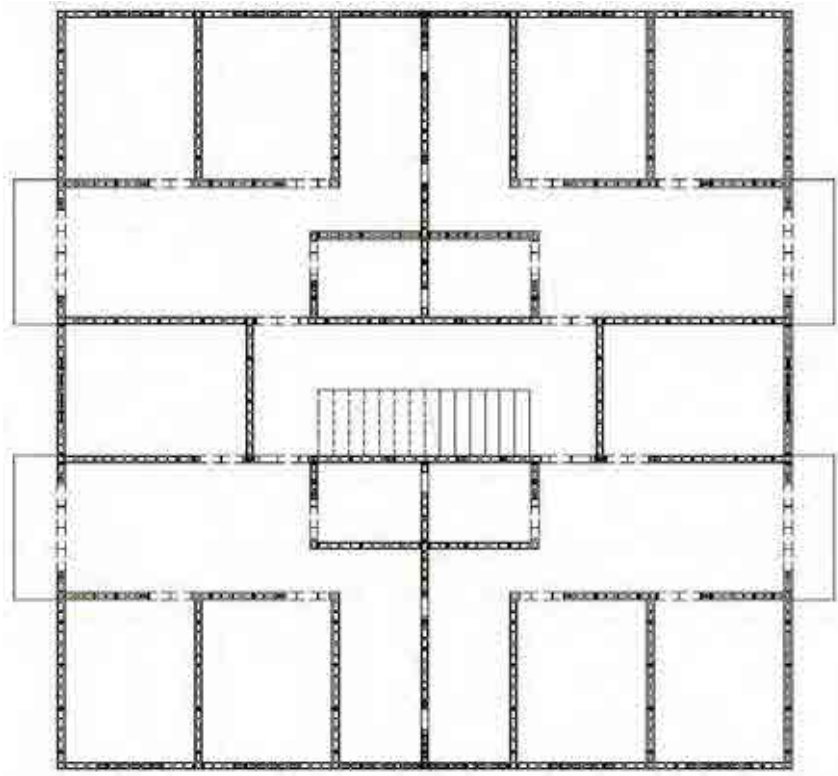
Planta do pavimento tipo em alvenaria estrutural
